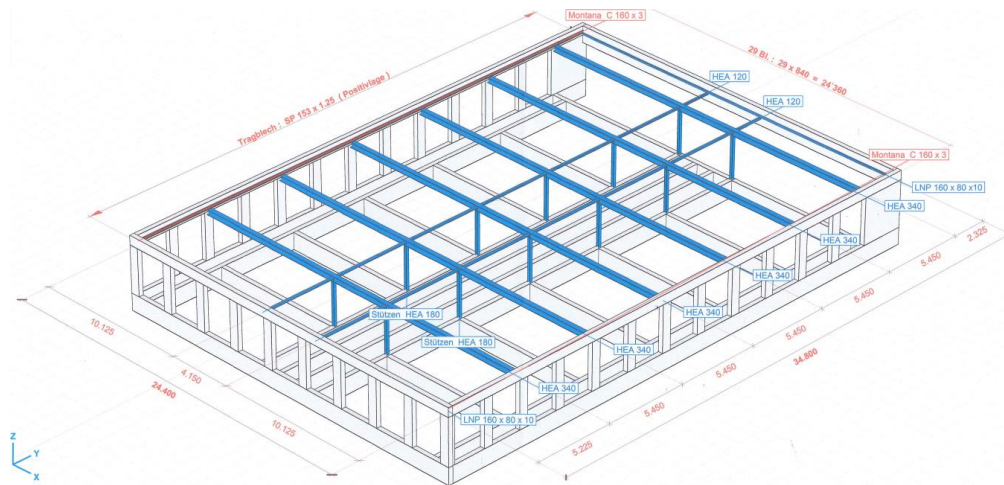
Vorgesehener Stahlbau der Filterhalle
